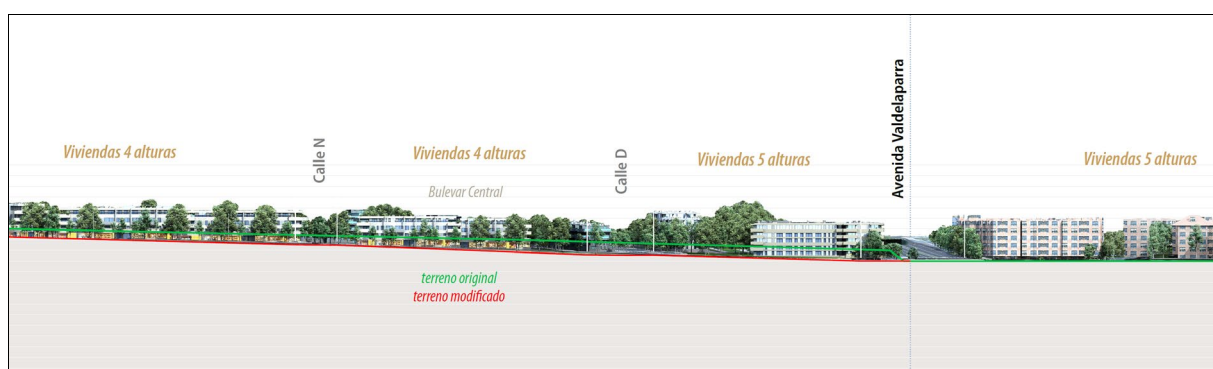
Sección transversal este-oeste desde la calle B hasta las viviendas existentes
